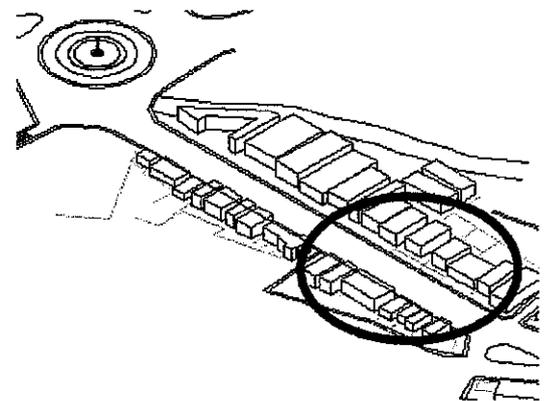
Penempatan Street Furniture (Halte Bis) sebagai tempat menunggu.
